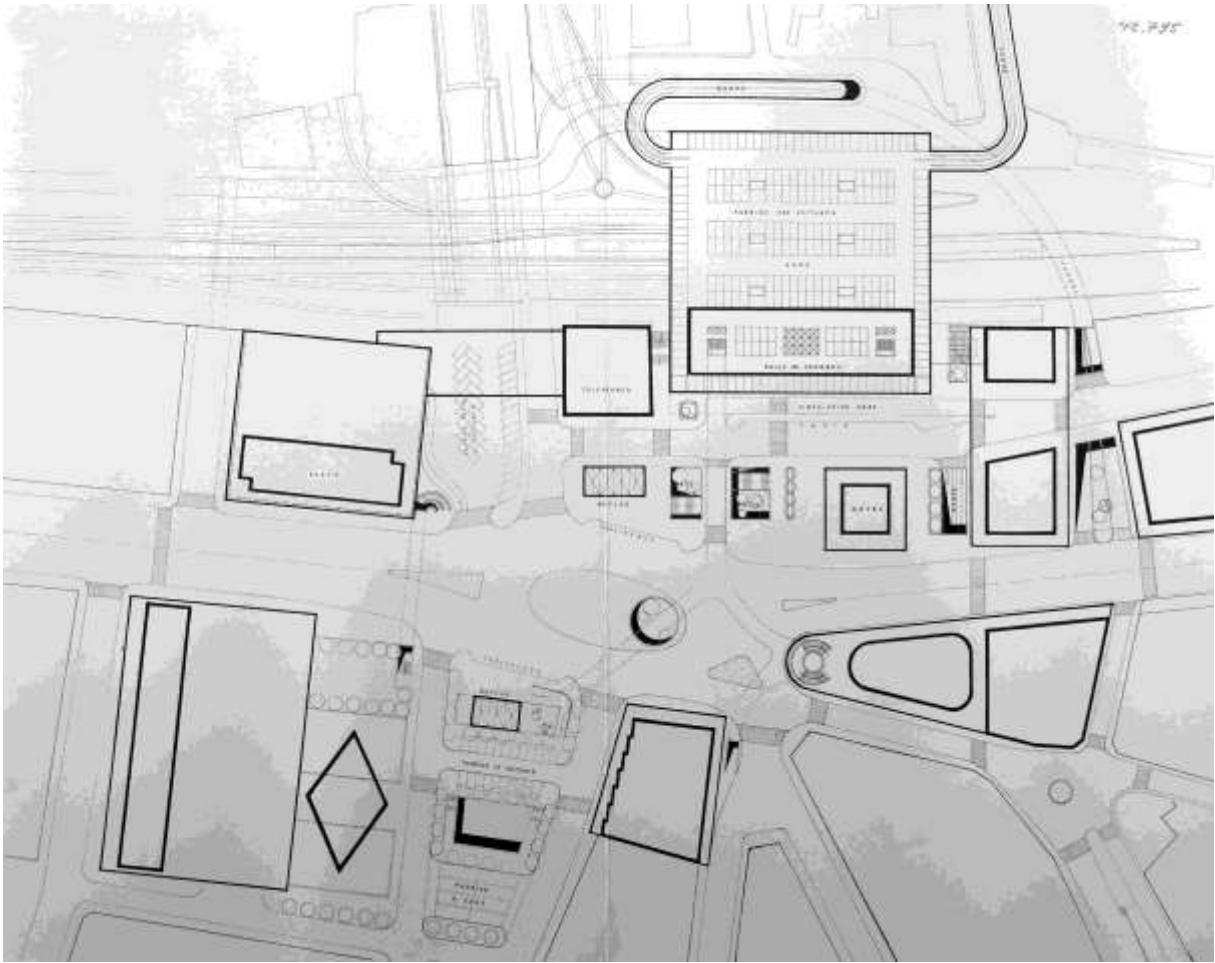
Place de la Gare, plan d'extension, J.-M. Jenny & R. Contreras architectes, 1965 (Service de l'urbanisme).
